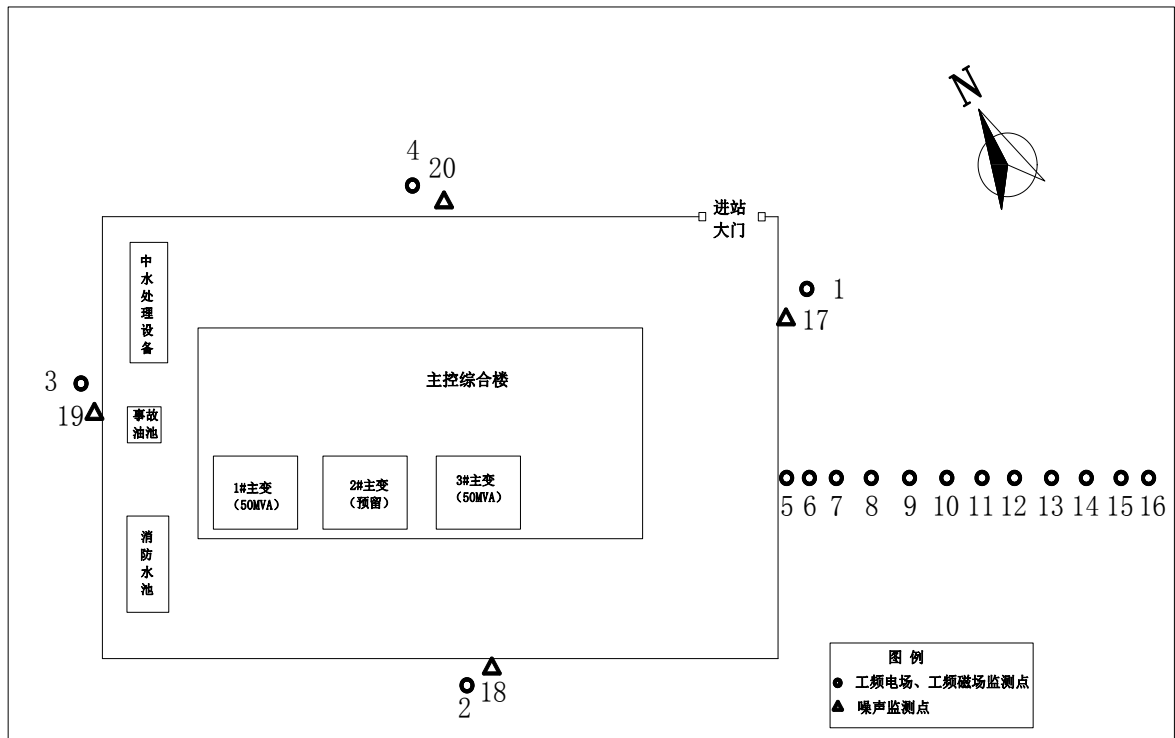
类比 110kV 六甲变电站站区总平面布置及监测点布置图
